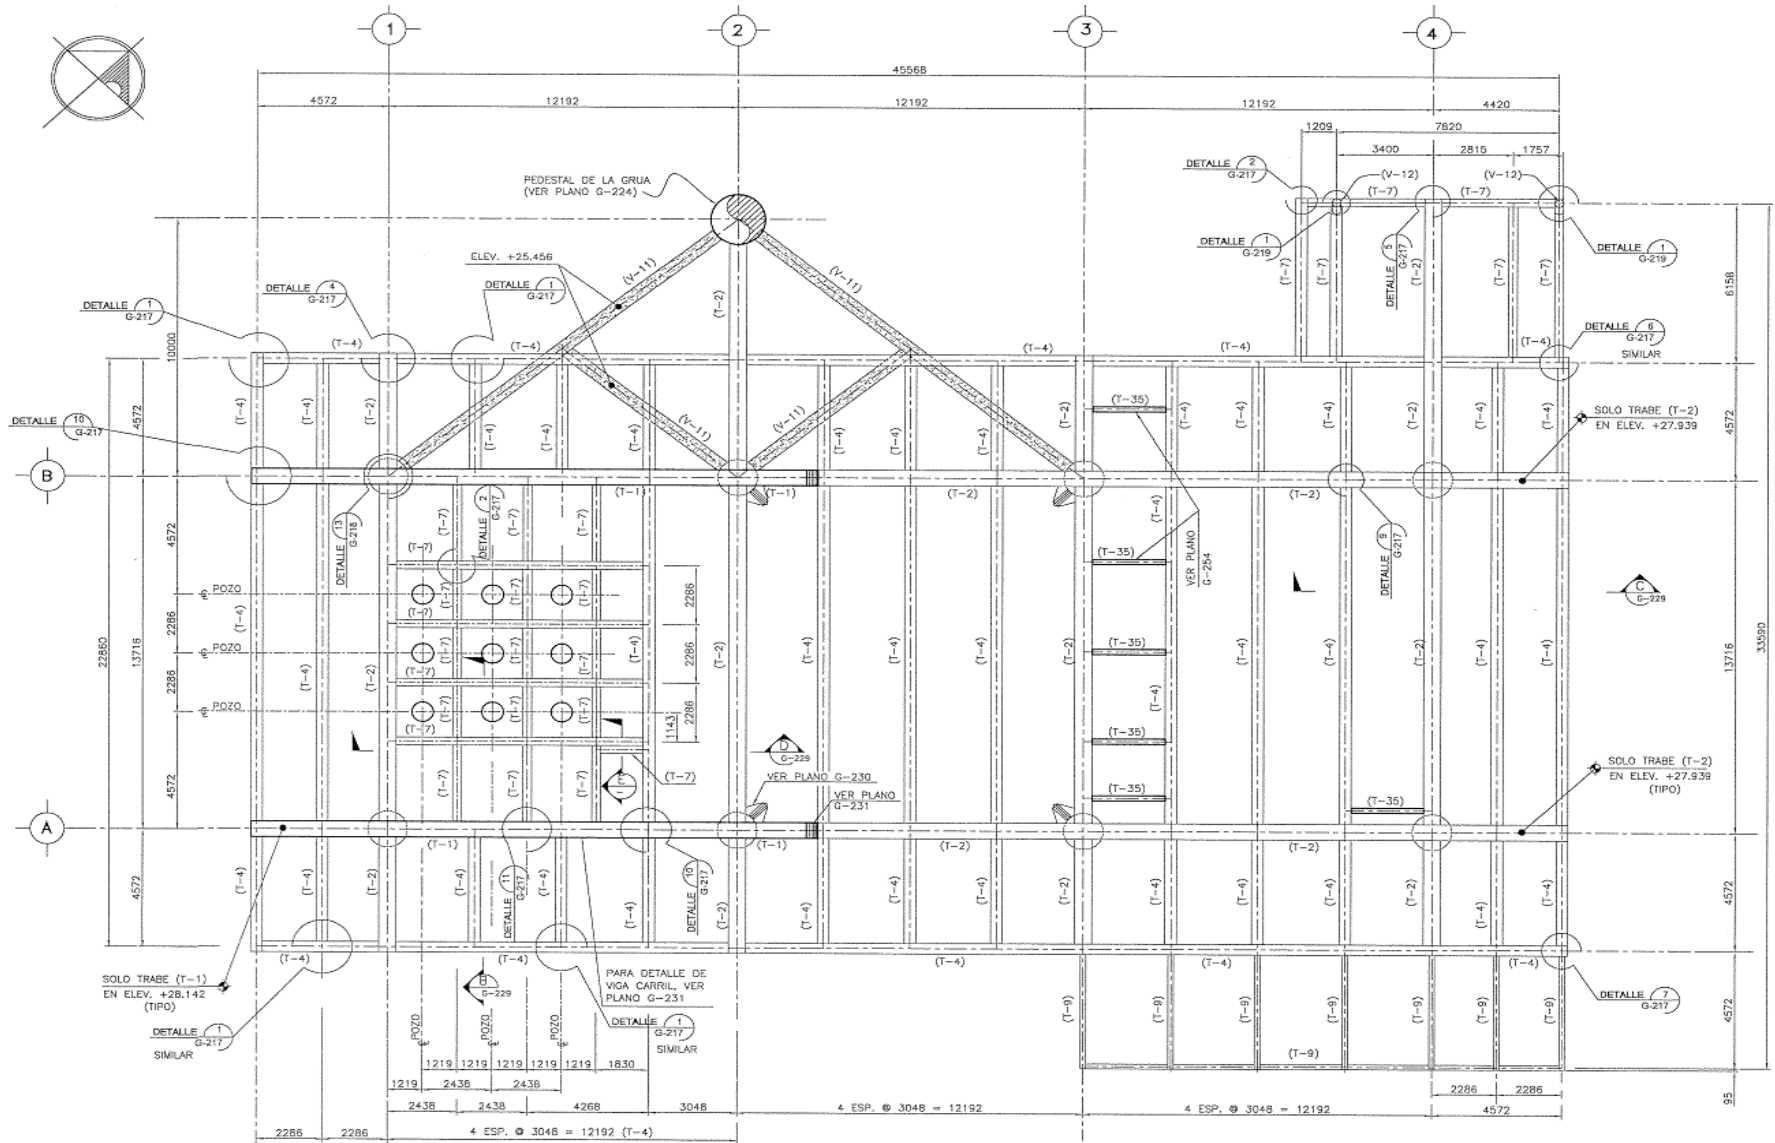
Planta estructural de la cubierta superior en elev. +27.590m de la plataforma ONEL-A
